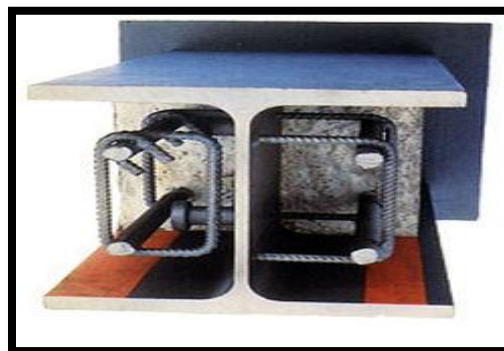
Modèle d'une poutre mixte ¹⁵⁶
